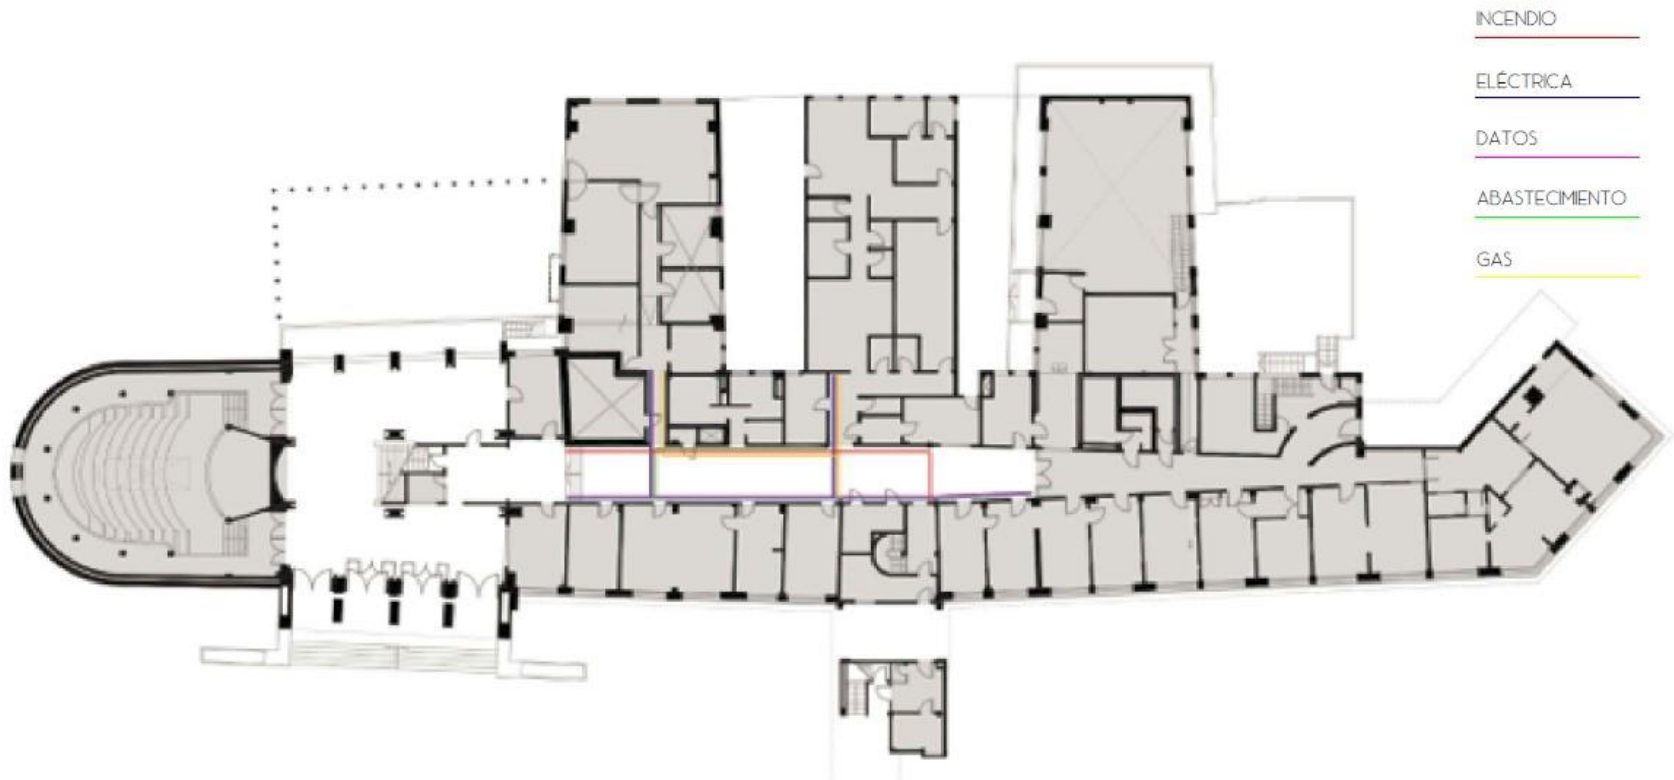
Planta Primer piso Instituto de Higiene, Propuesta Instalaciones Fuente: Archivo DGA Uruguay.
